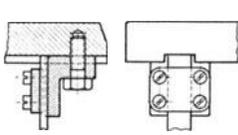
Verschraubung: Aufnahme von Zug durch von Schrauben erzeugte Reibung.
